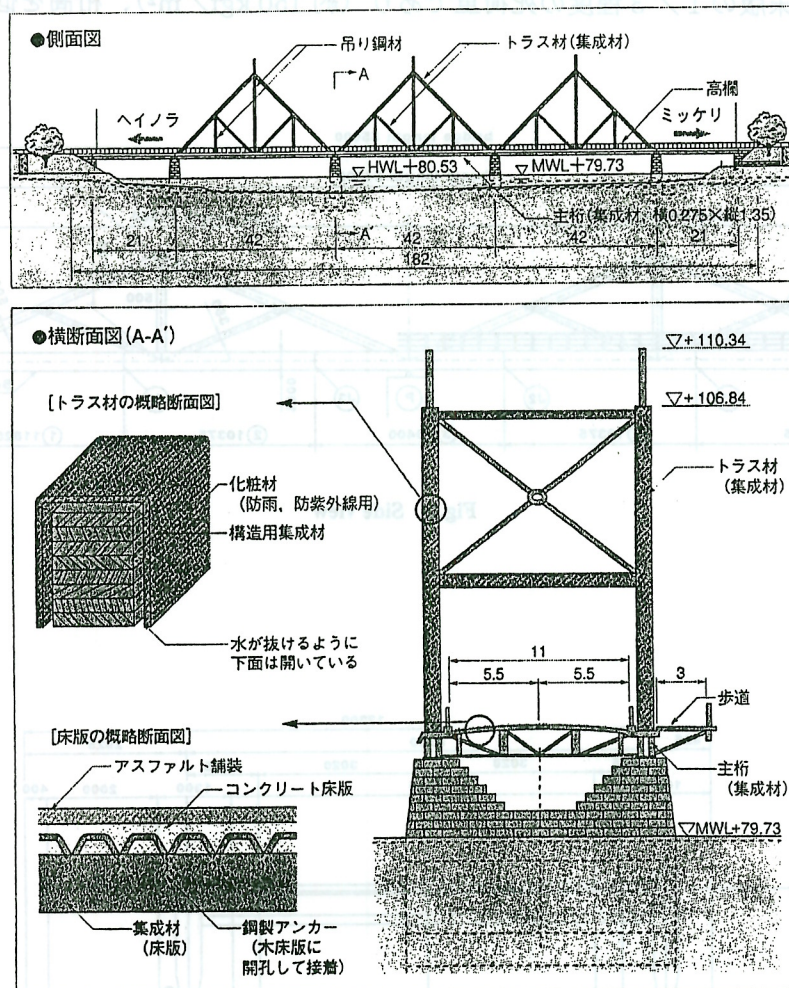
キングポストトラス橋（フィンランド、1999年架設）
